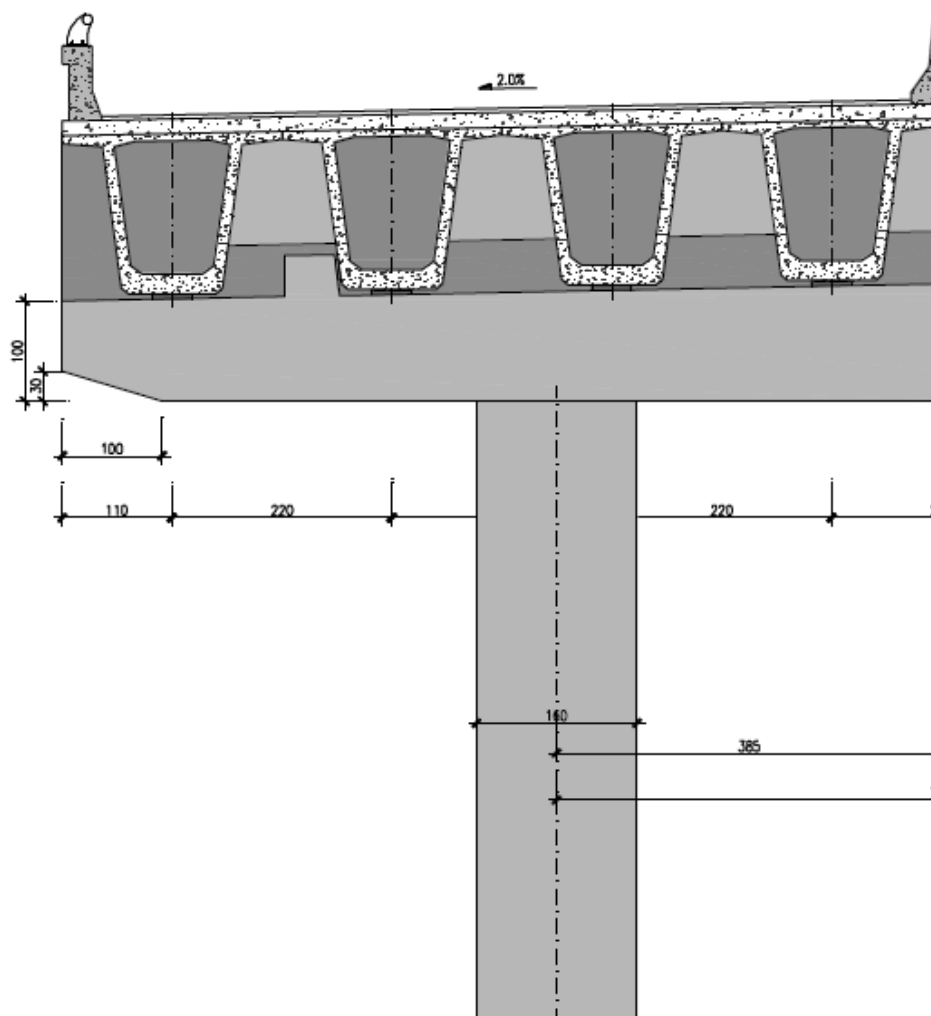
Pormenor da ligação pilar-tabuleiro num corte transversal [10]
